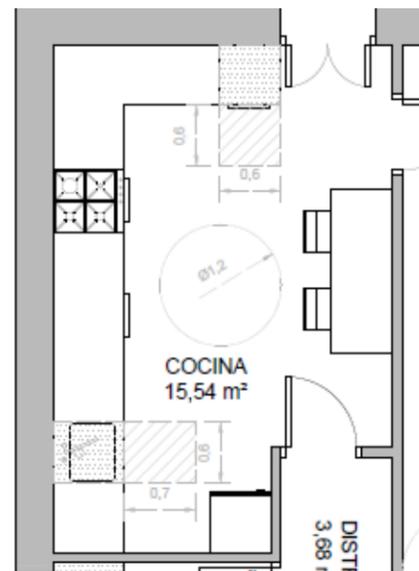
Cocina estado propuesto planta primera<sup>17</sup>
